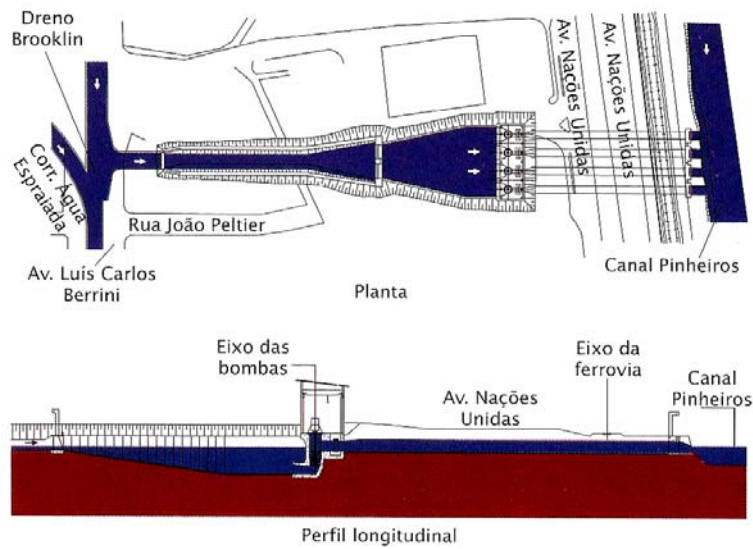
Esquema do sistema de bombeamento (APUD Canholi, 2005)
